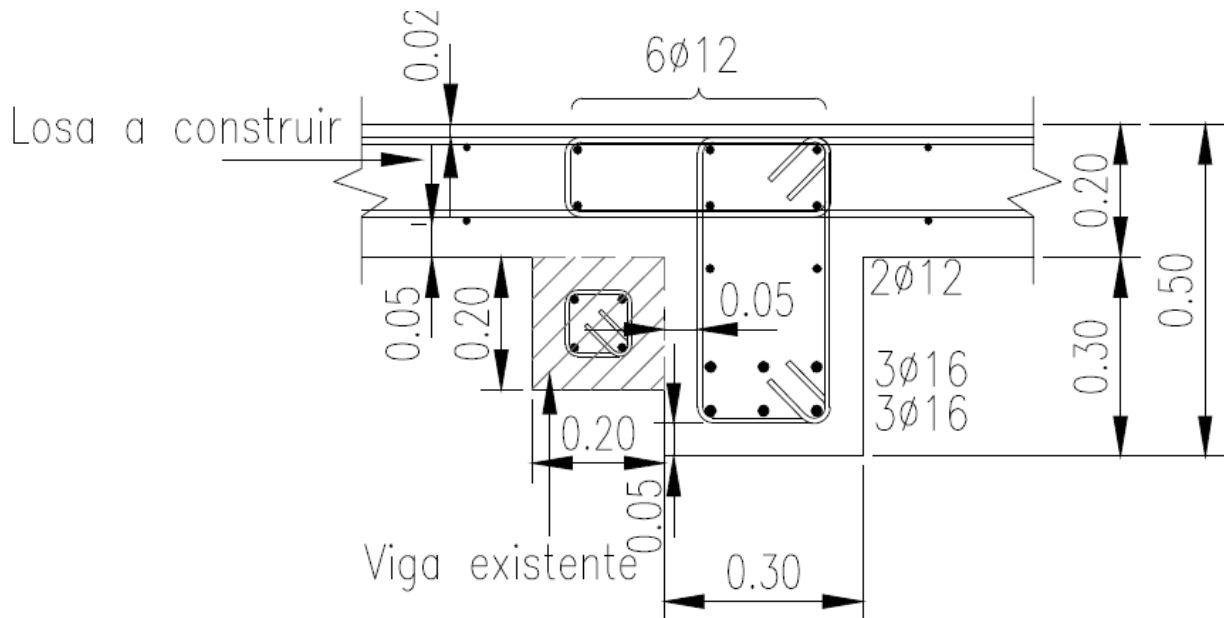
Ingeniería de detalle en sección transversal de refuerzo de vigas de fundación con ubicación de losa a nivel $-9.40m$.
